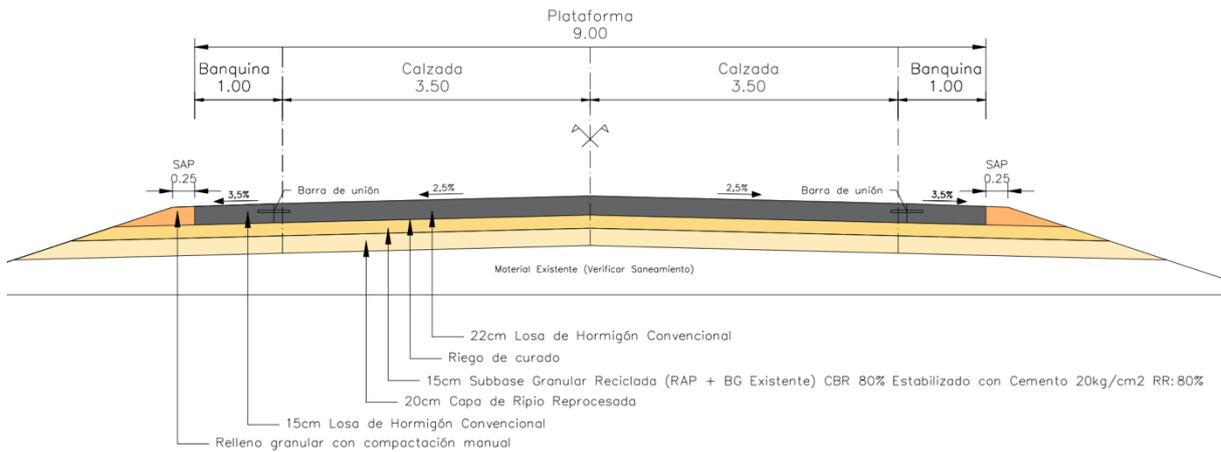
Sección transversal tipo de pavimento rígido convencional
